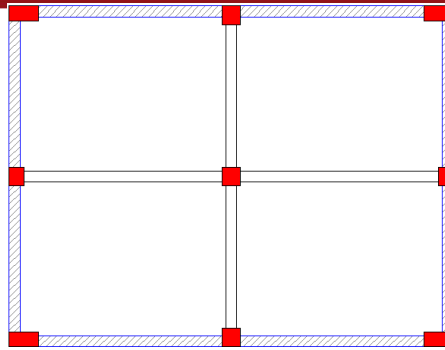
Vista en planta de un edificio con vigas de borde conectadas excéntricamente a sus columnas.
